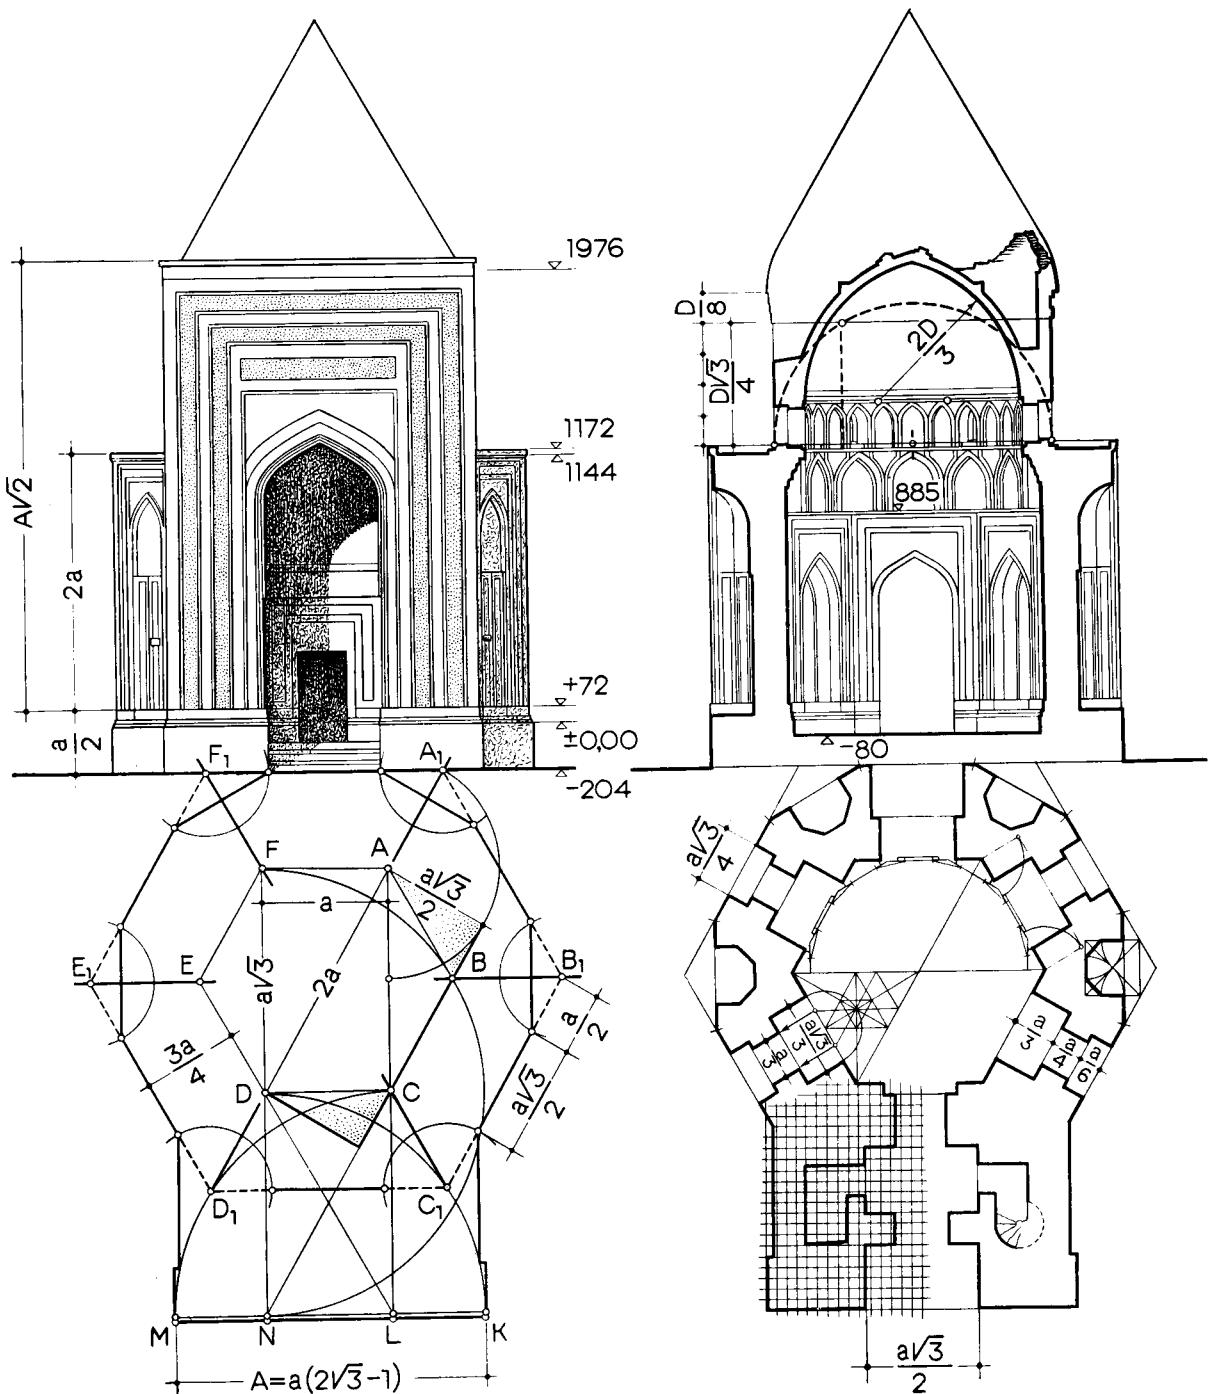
Мавзолей Тюрабек-ханым. План фасада и разрез.
